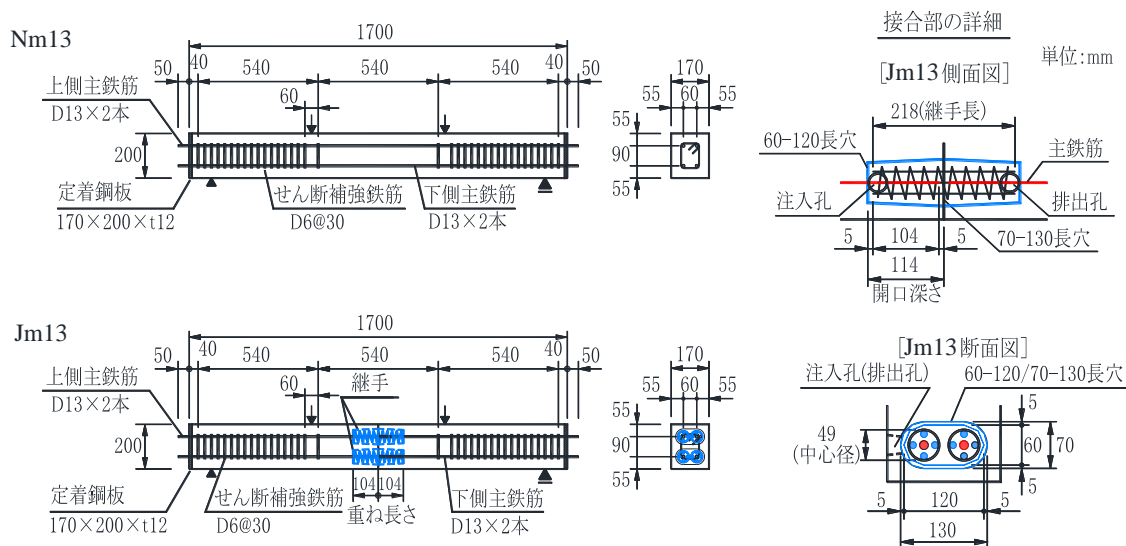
試験体の形状寸法と配筋 (D13 シリーズ)
